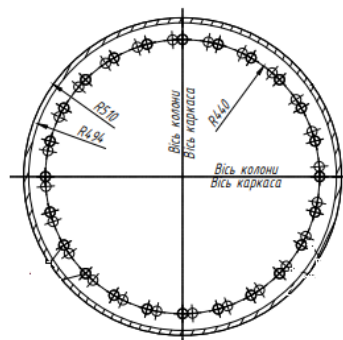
Конструктивна схема перерізу трубобетонної колони
